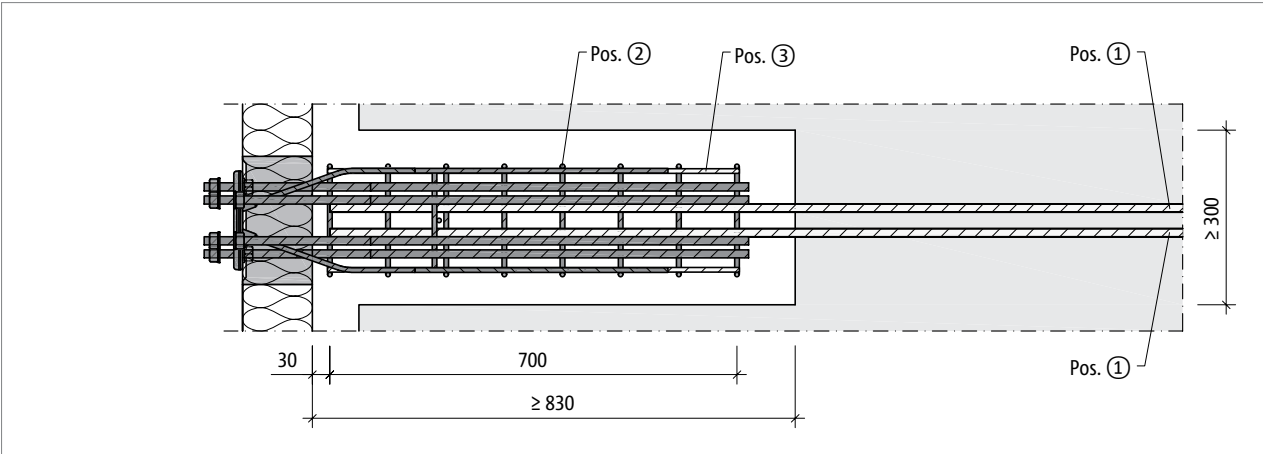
Schöck Isokorb® XT Typ SK-MM1-VV1: Bauseitige Bewehrung bei Halbfertigteilbauweise, Grundriss
